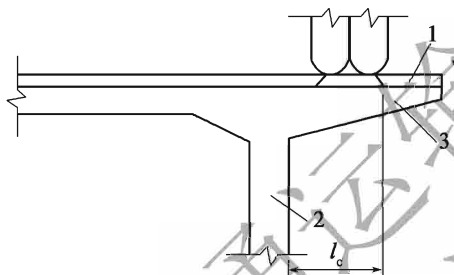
Répartition des roues sur la dalle en encorbellement
